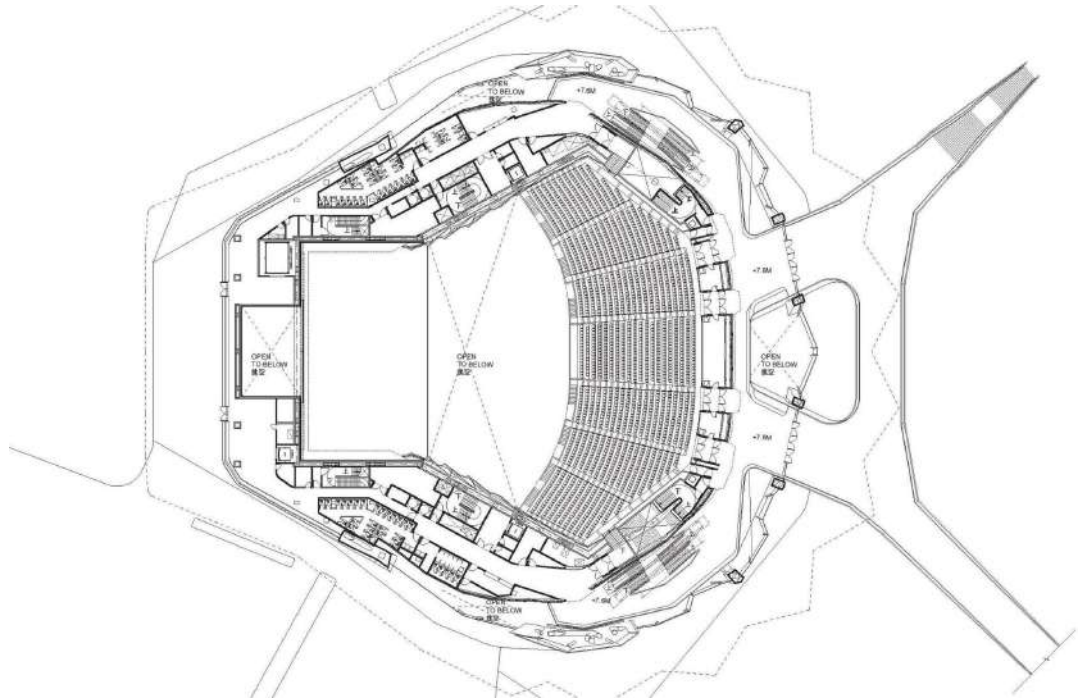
План 2-го поверху будівлі Тайбейського музикального центру [8]
